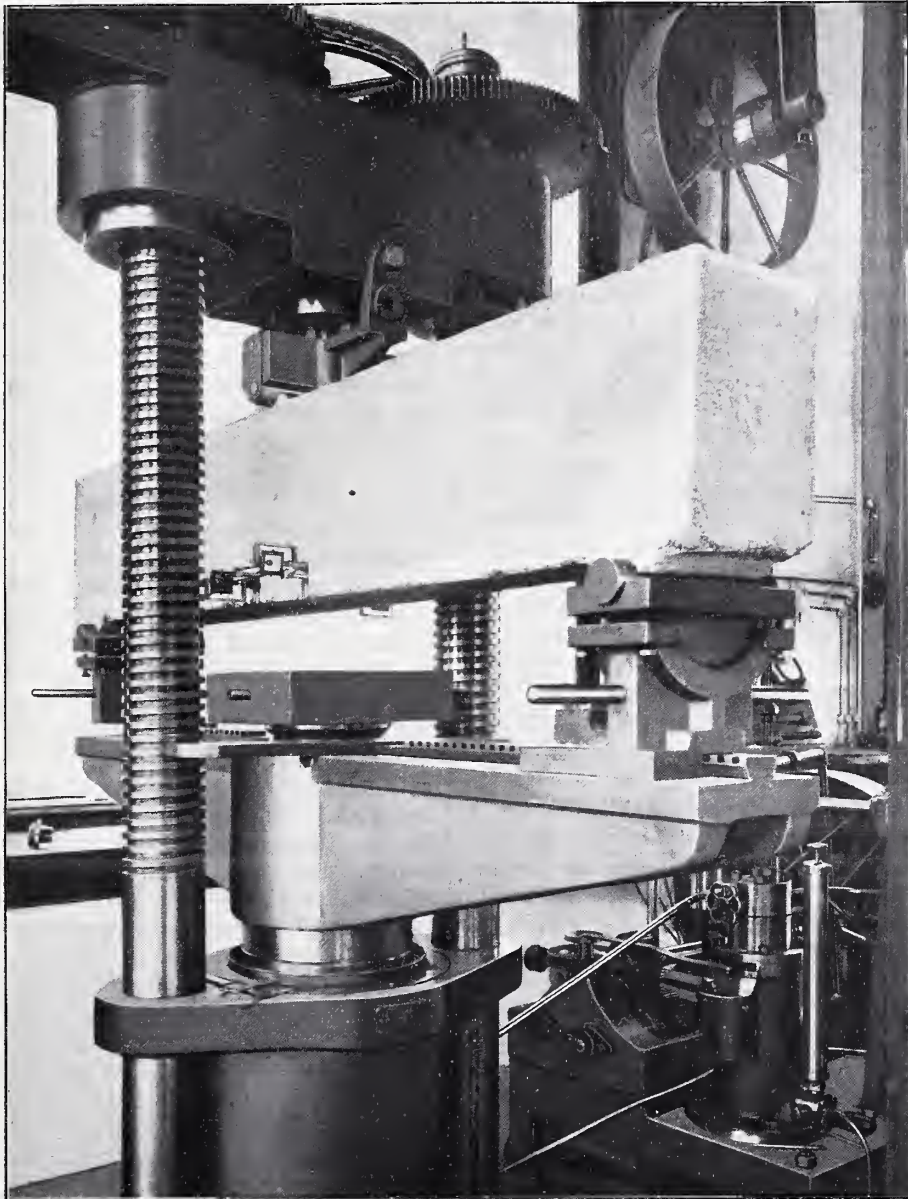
Disposition des poutres B et C pour l'essai à la flexion sur la presse Amsler.
